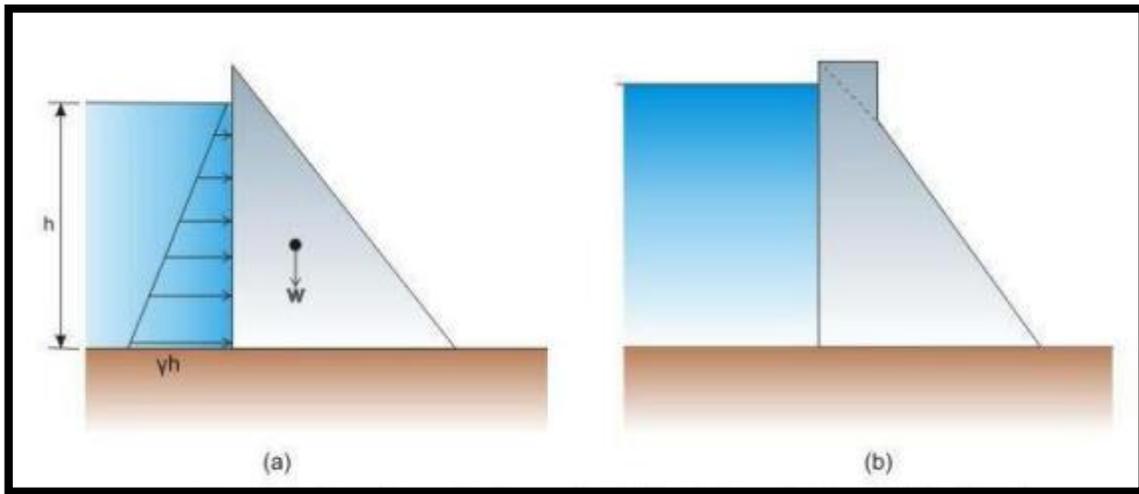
coupe d'un barrage poids (Sadiq, 2022)
